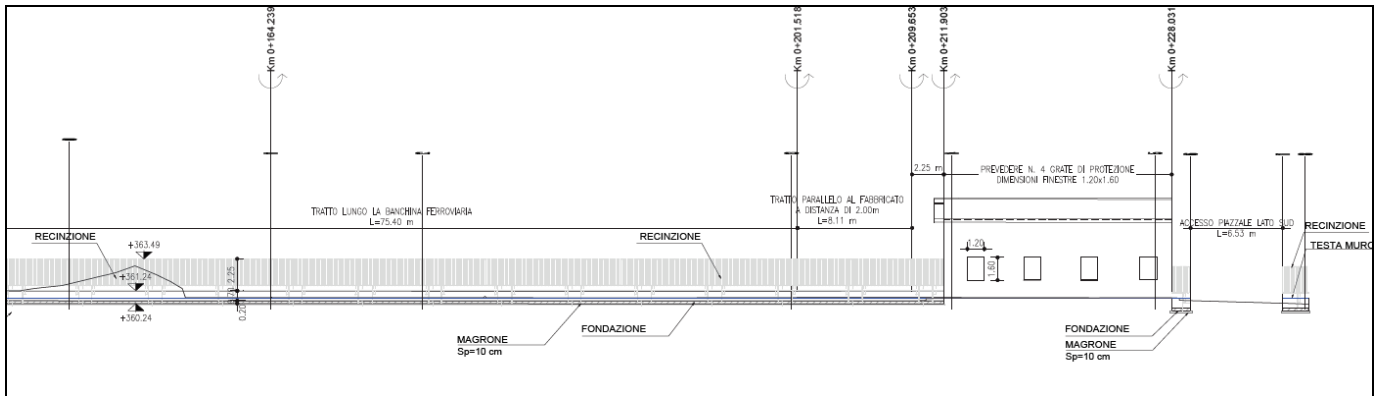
Prospetto muri di sostegno piazzale SSE di Albano
